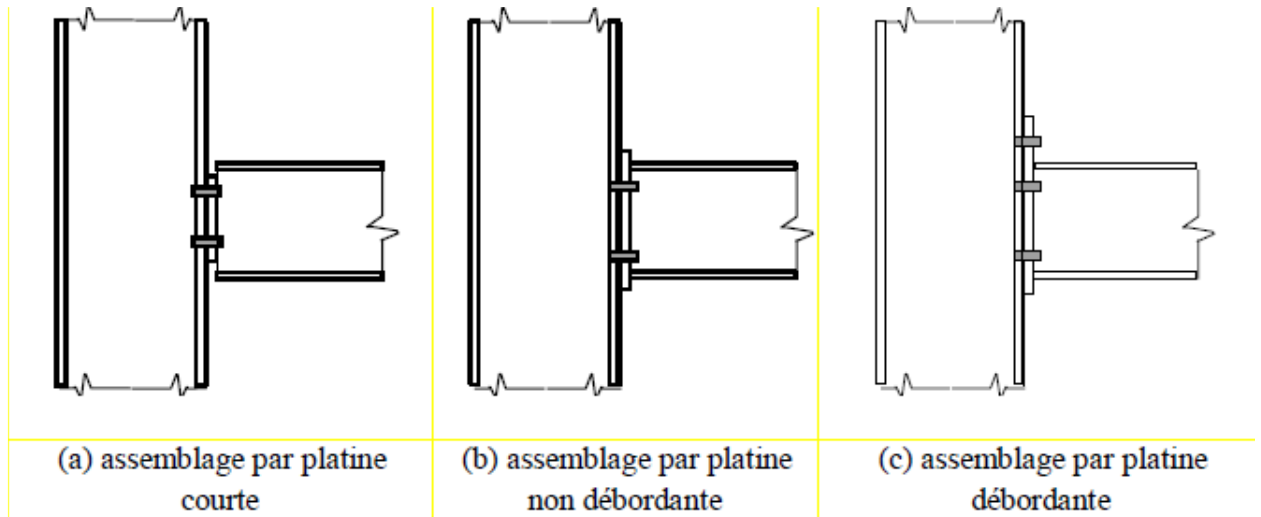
Assemblage poteau poutre par platine d'extrémité boulonnée
